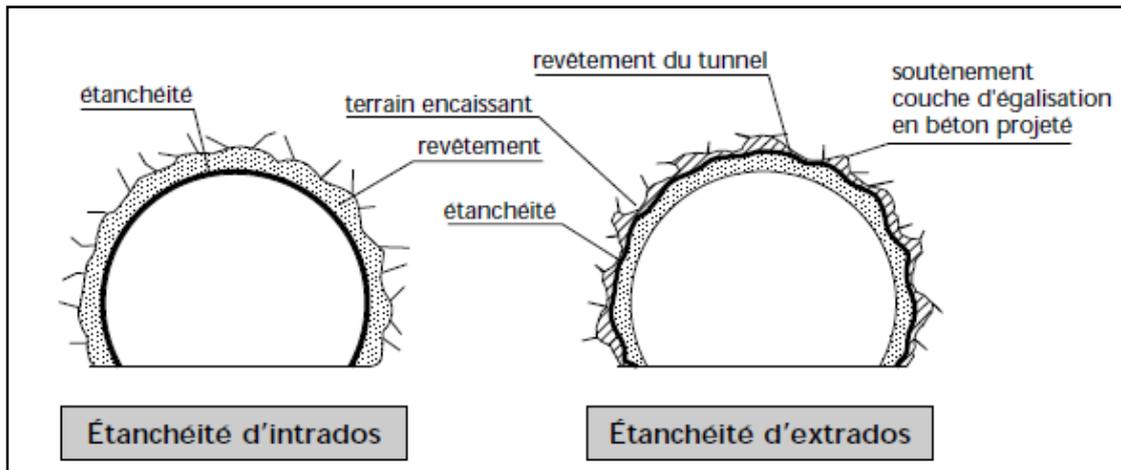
principaux types d'étanchement (cas d'un tunnels)
